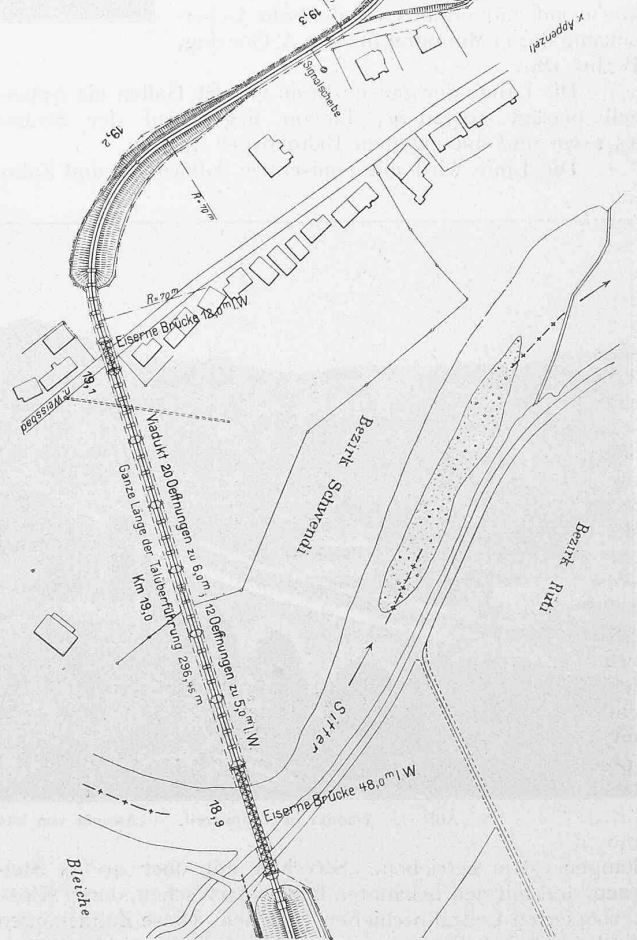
Die Station Appenzell mit dem Viadukt. Lageplan. — Massstab 1 : 3000.
